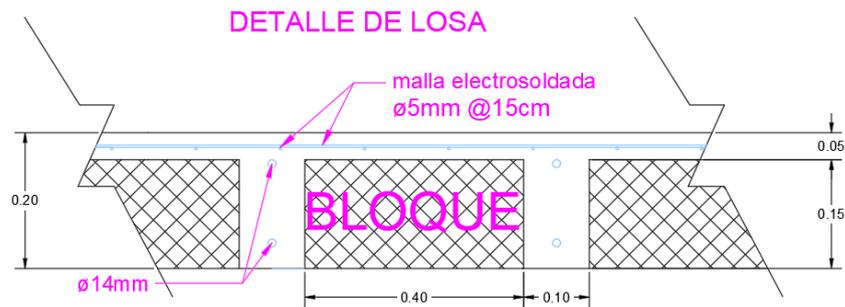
Detalle de losa en plano estructural [AutoCad]
